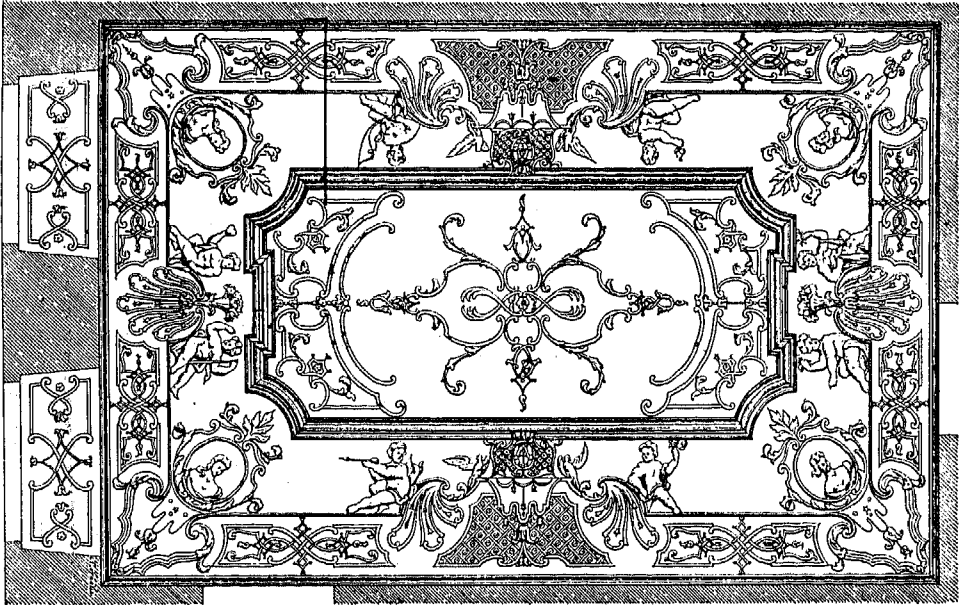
Lichtenstein; Decke im ersten Obergeschoss.
